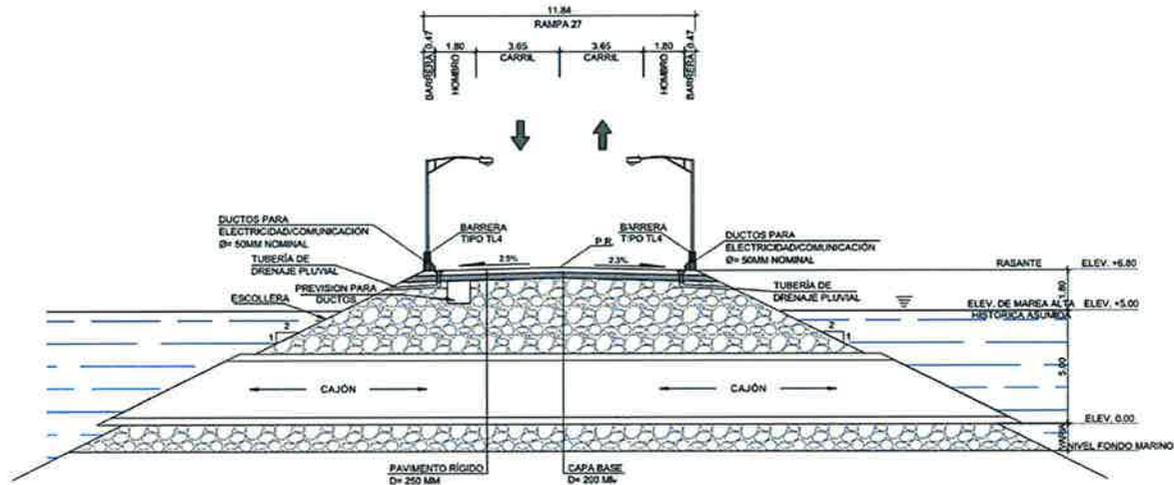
Vista general de planta, Rampa N° 27. Fuente: MOP.
